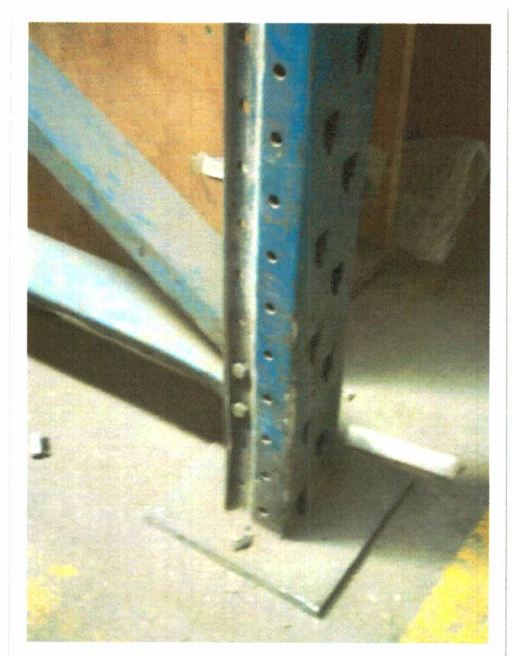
VISTA DE APOYO DE ATRIL SIN FISURAMIENTOS EN PAVIMENTO.
